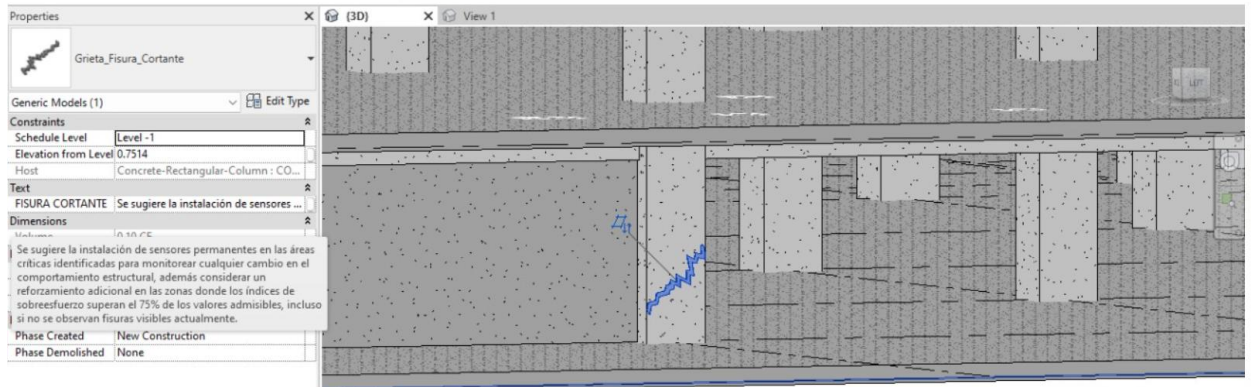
Recomendación técnica patología presentada en la columna Fuente: Elaboración propia.
